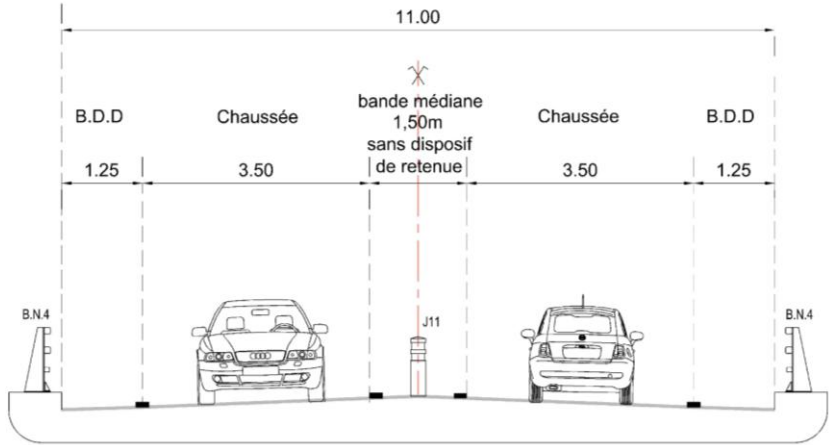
Profil en travers pour route à 2x1 voie à chaussées séparées au droit d'un ouvrage d'art
